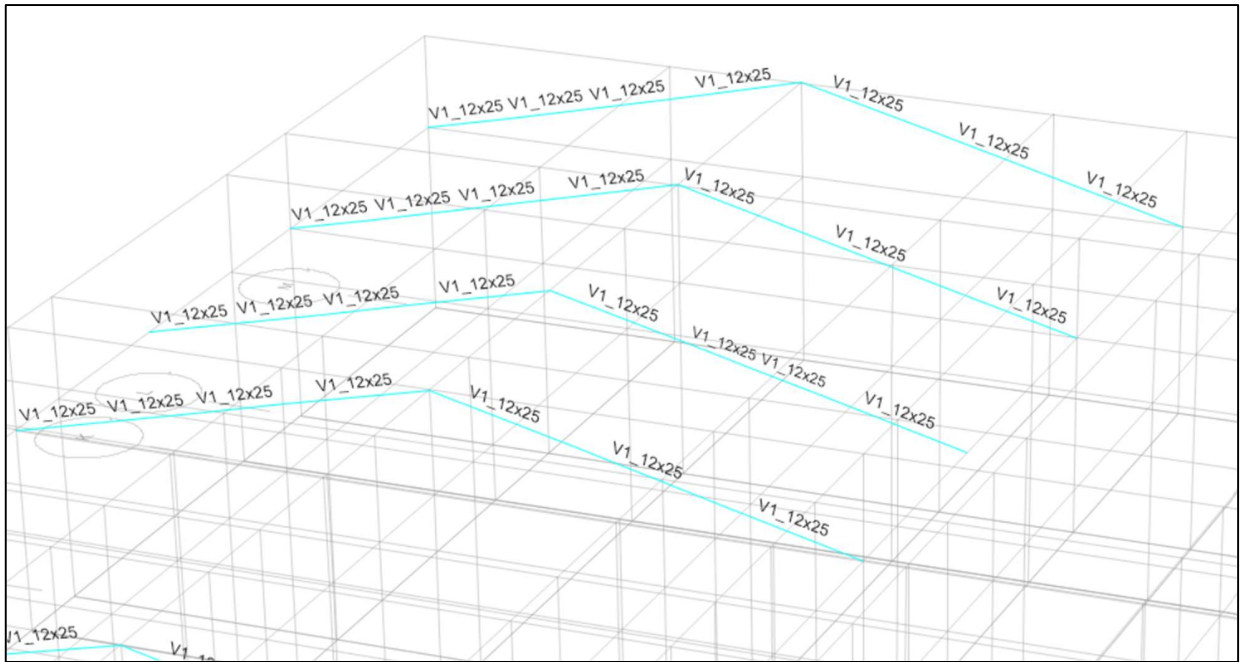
Secciones de vigas de cubierta (V1\_12CMX25CM). Sector entre ejes I-M y I-5.
